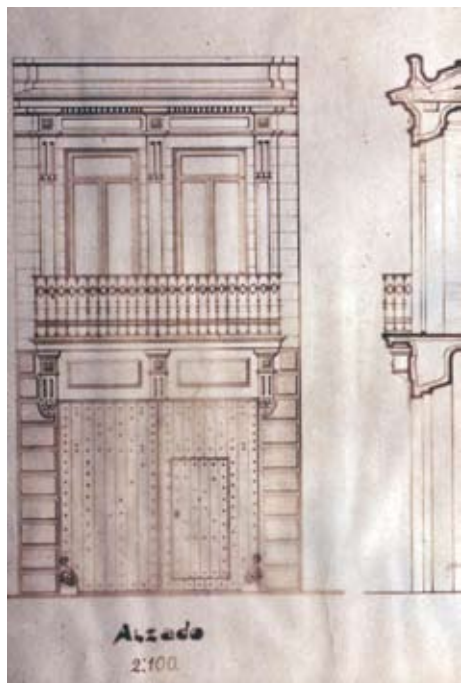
Alzado y sección Callejón de las Portadas, 1924.
